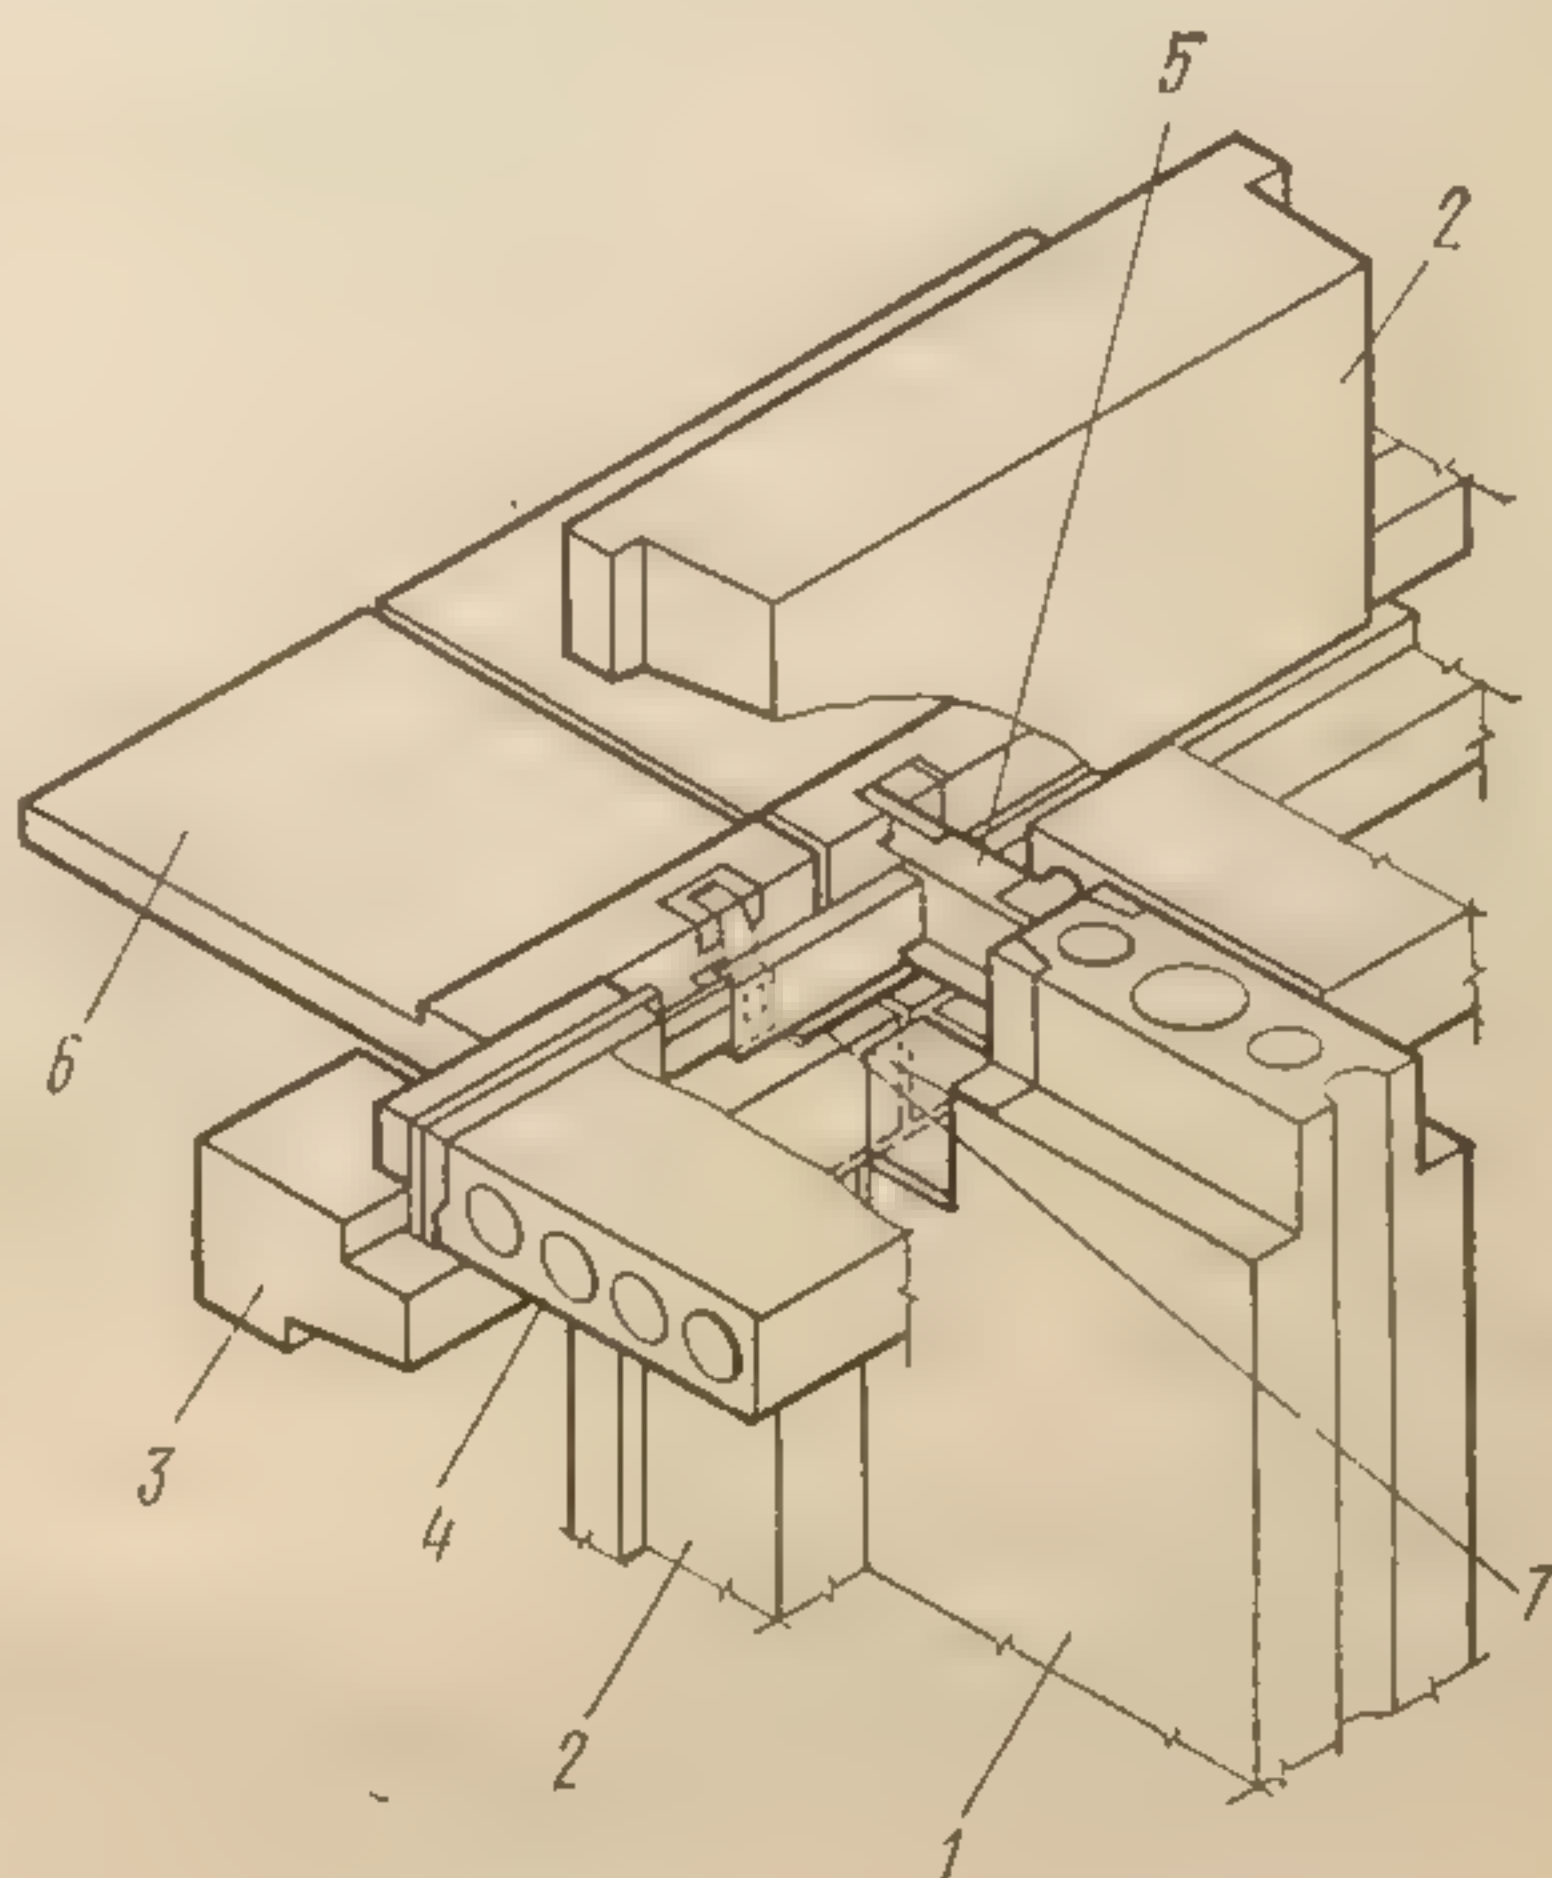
Узел сопряжения несущих конструкций 14-этажного крупноблочного жилого дома с поперечными несущими стенами:
